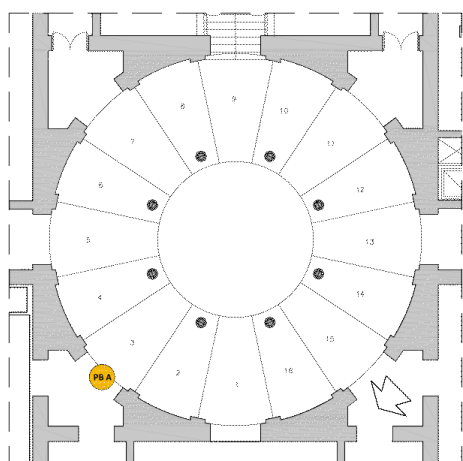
Planta Baja, Sector Acceso. Ubicación del datalogger (DGCyM UNLP; García Santa Cruz, M.G., 2018)
